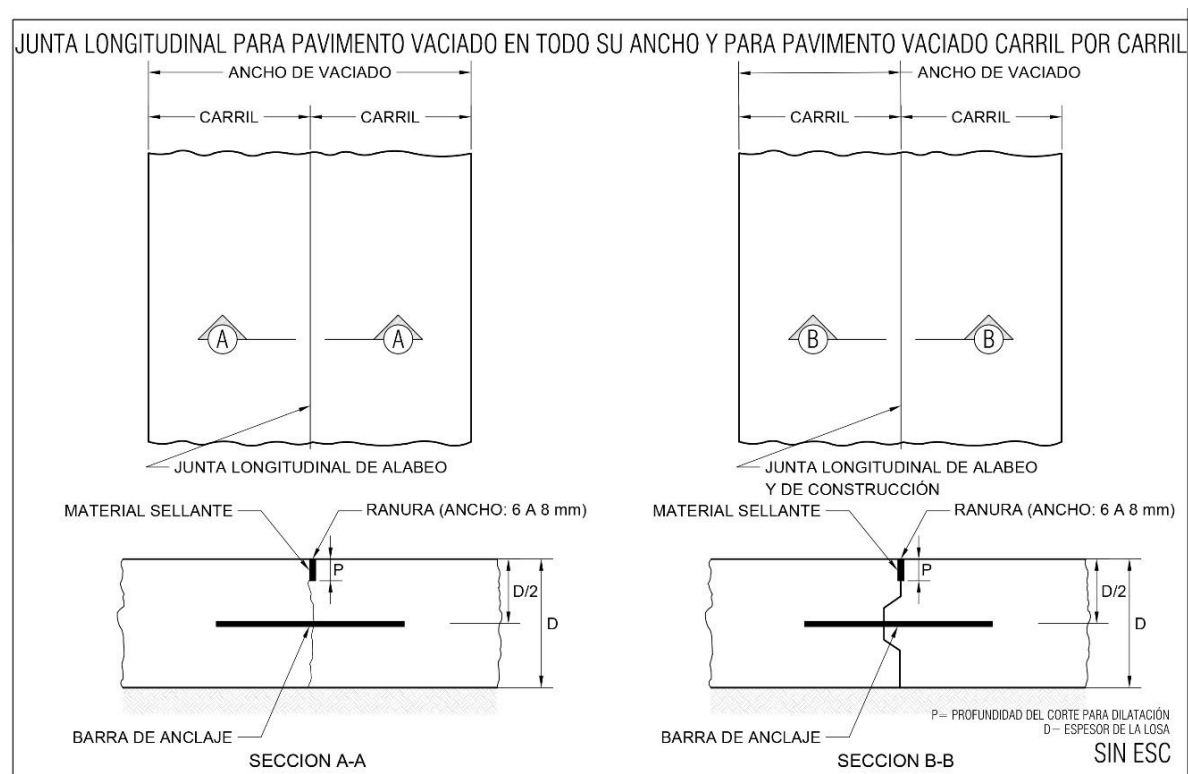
Junta longitudinal para pavimento vaciado en todo su ancho y vaciado carril por carril
